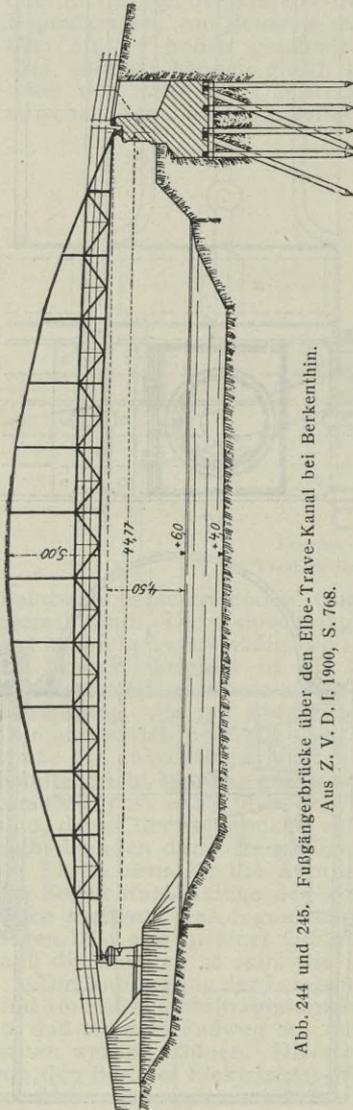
und 245. Fußgängerbrücke über den Elbe-Trave-Kanal bei Berkenhthn.
